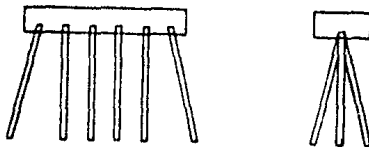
Pilas formadas por conjunto de pilotes.
